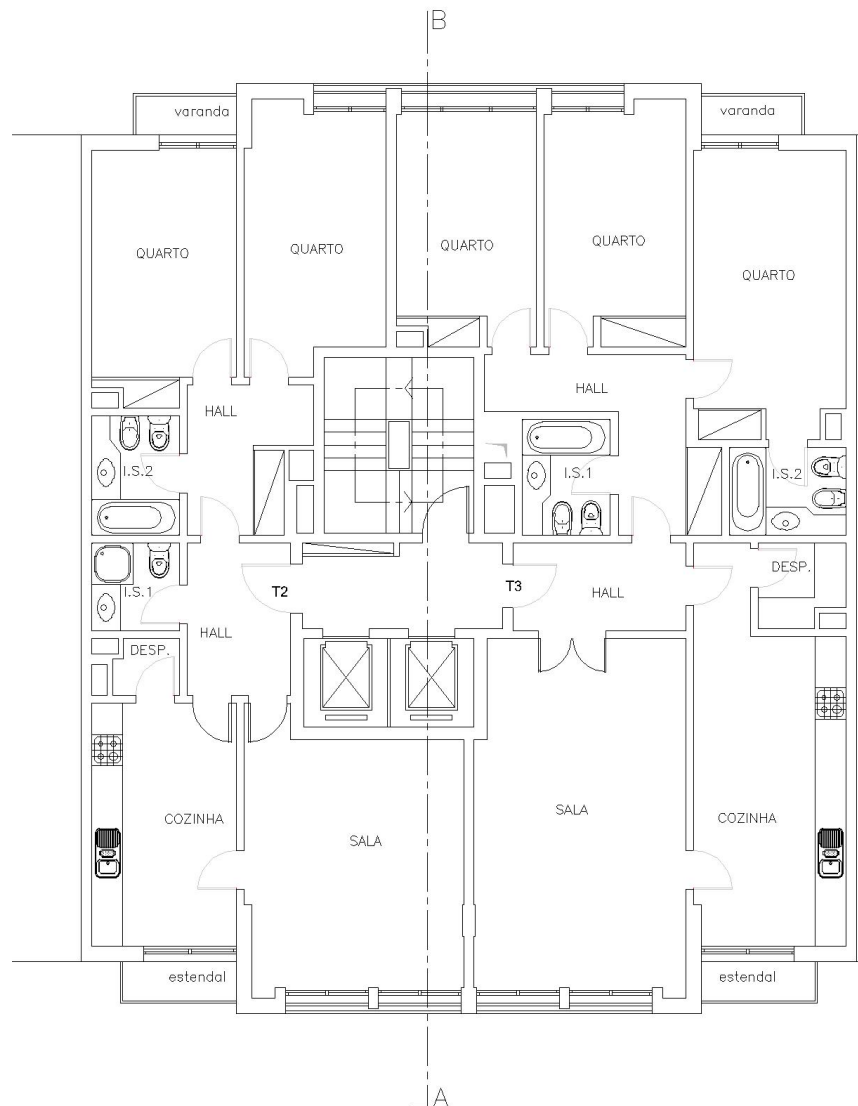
Planta da arquitetura tipo do caso de estudo 2.
